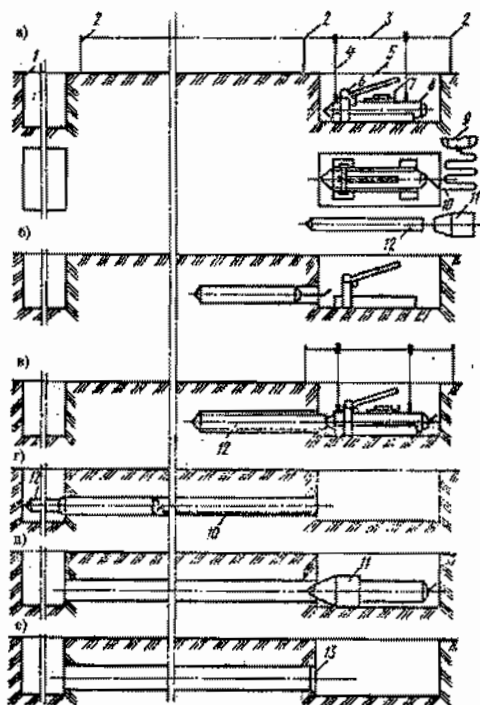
Схема производства работ при пробивке скважин пневмопробойником: а, б - нацеливание и запуск пневмопробойника; в - установка удлинителя; г - пробивка скважины; д - установка расширителя; е - готовая скважина; 1 - приемный приямок; 2 - вешки; 3 - шнур; 4 - отвес; 5 - входной приямок; 6 - стартовое устройство; 7 - линейка с уровнем; 8 - пневмопробойник; 9 - компрессор; 10 - шланг; 11 - расширитель; 12 - удлиннитель; 13 - заглушка
